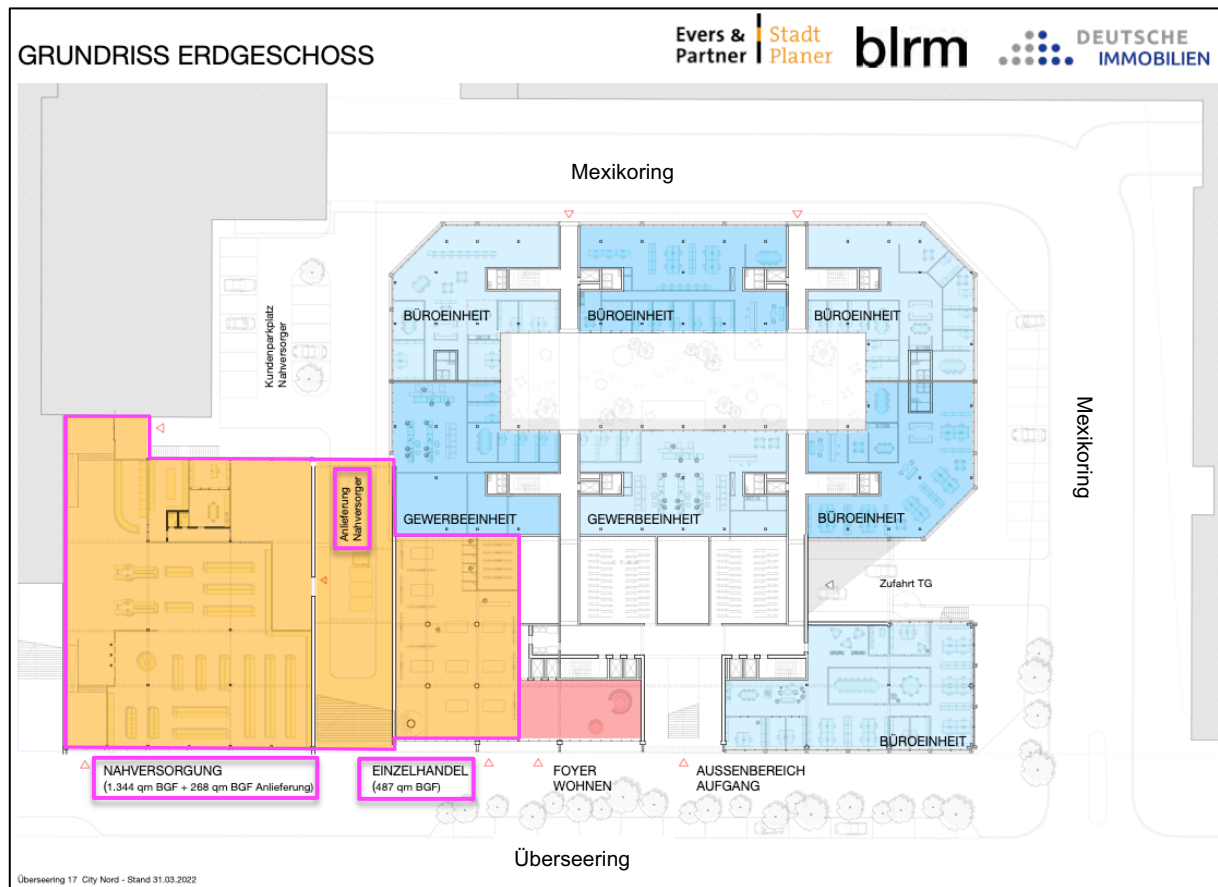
Lage und Flächenangaben zu den in die UVVP-A eingestellten Einzelhandelsflächen
